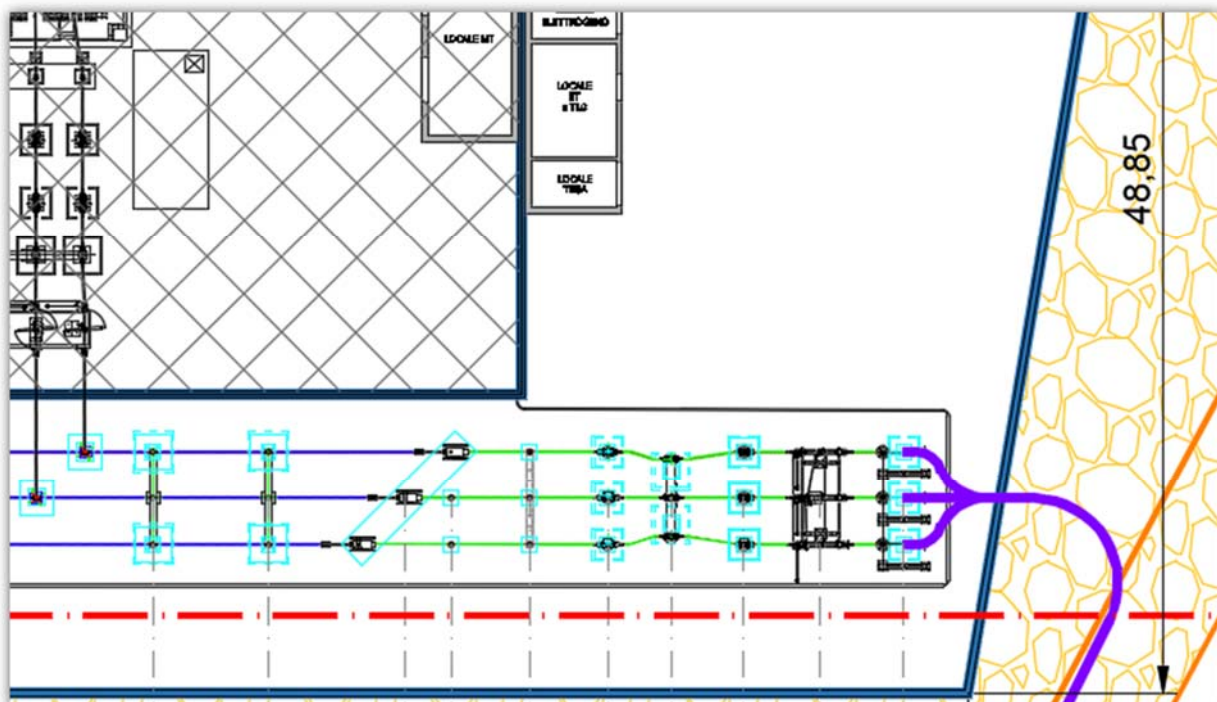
Planimetria elettromeccanica dello Stallo di Arrivo nell'Area Comune.
